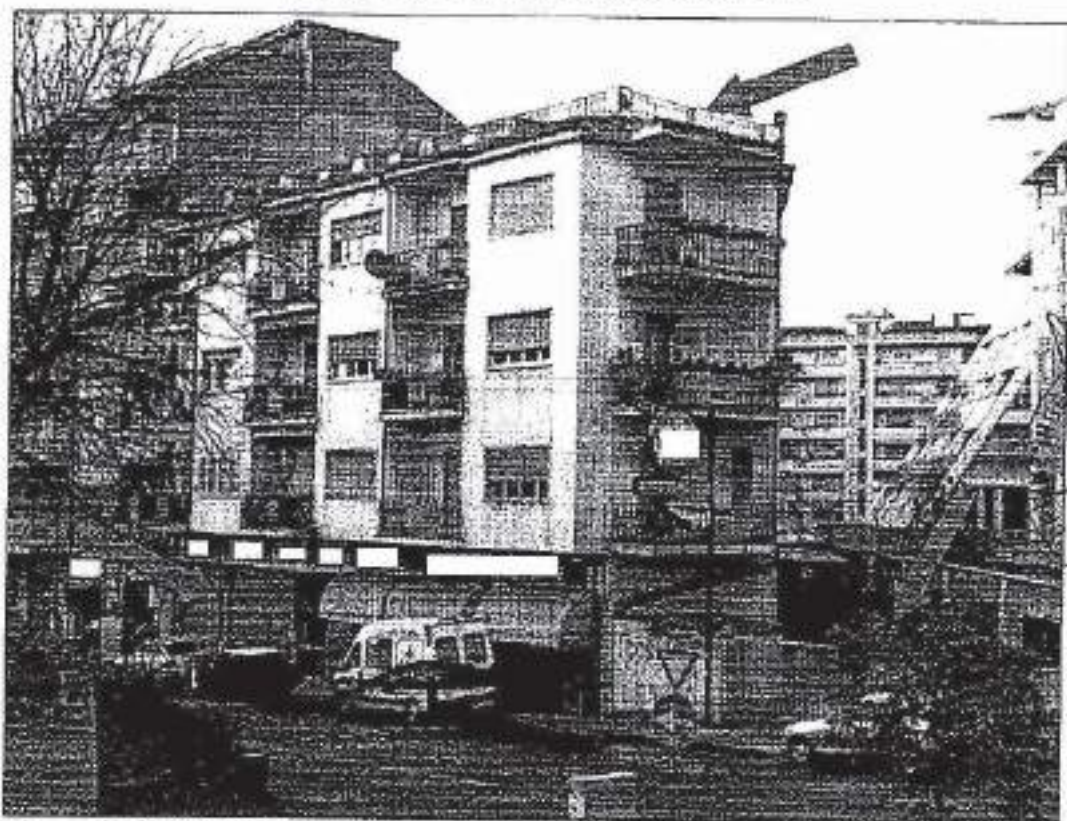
Fabbricato edificato sulla Part. 138 del Fg 3 di Cosenza, Via Panebianco con vista del Lotto 1, dell'ingresso alla corte e del lastrico solare del Lotto 2
